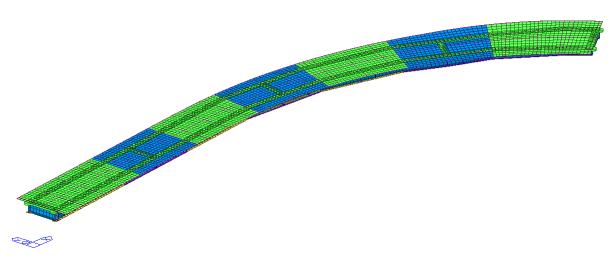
Vista 3D del modello dell'impalcato (Rampa D)
